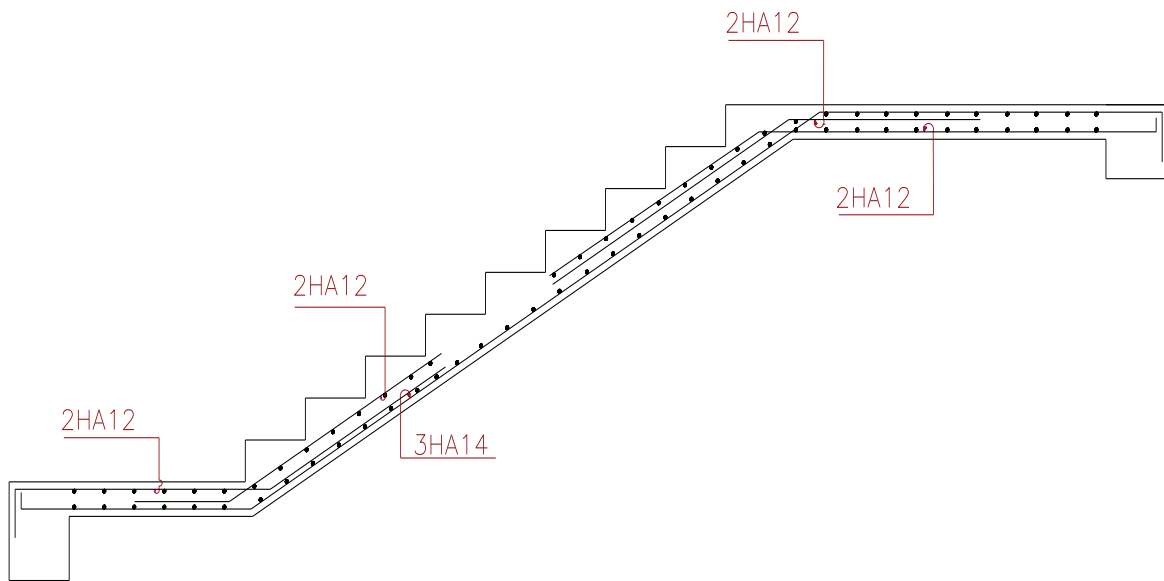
Ferrailage d'escalier sous-sol type 02.
